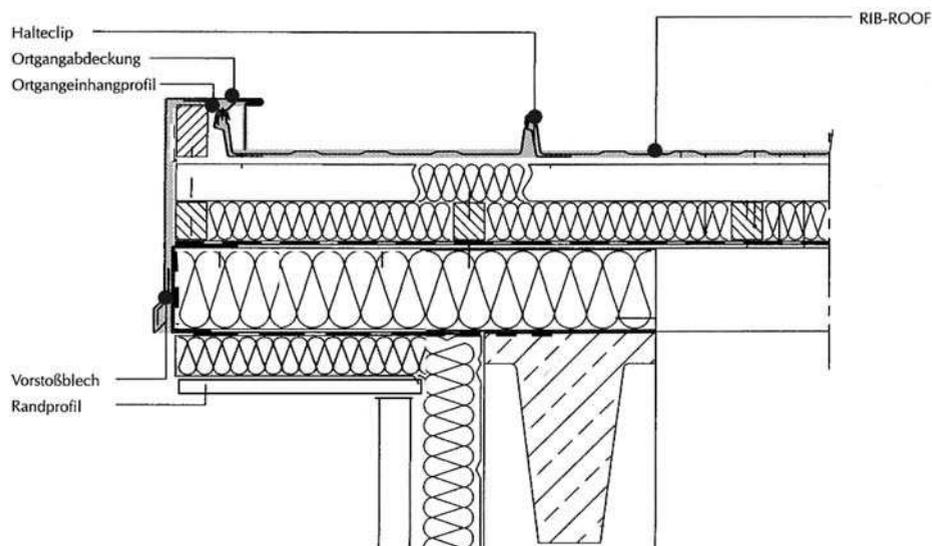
Ortgangausbildung mit Dachüberstand unter einer Klemmfalzprofildeckung
